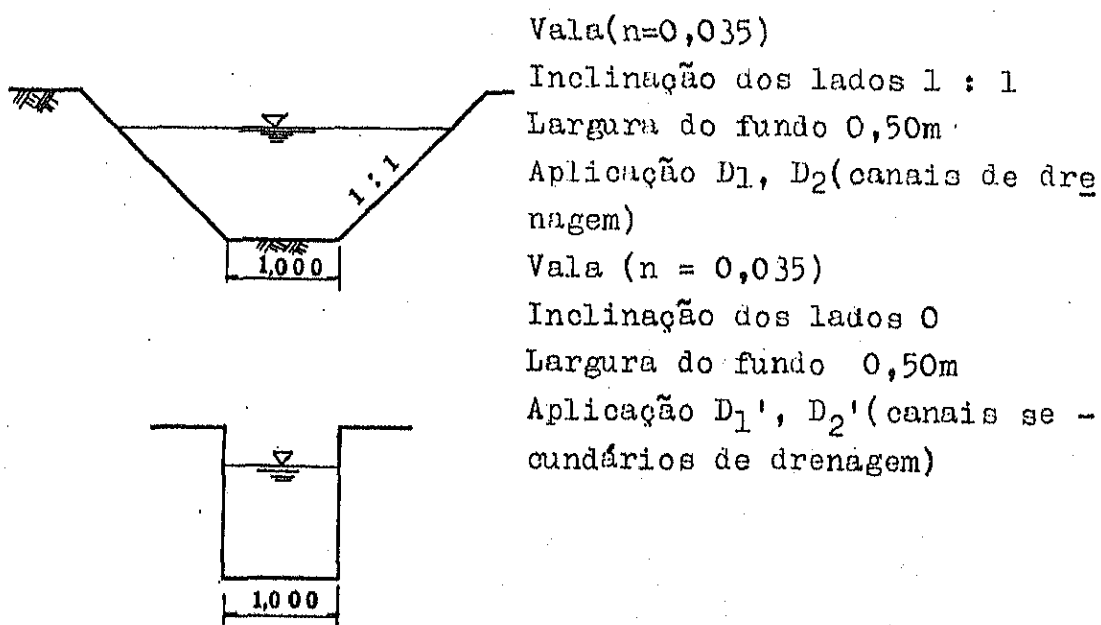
INCLINAÇÃO PLANEJADA DO DRENO
